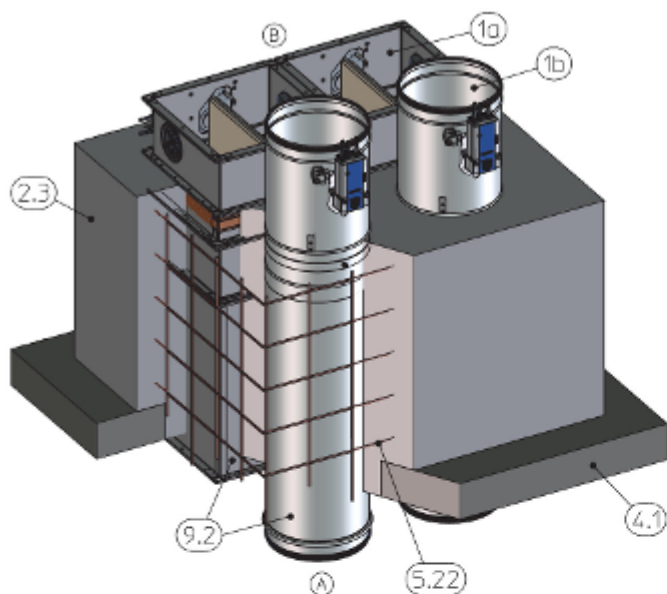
Montage au mortier avec une base en béton dans une dalle de plafond pleine, verticalement, FK2-EU et FKRS-EU associés
